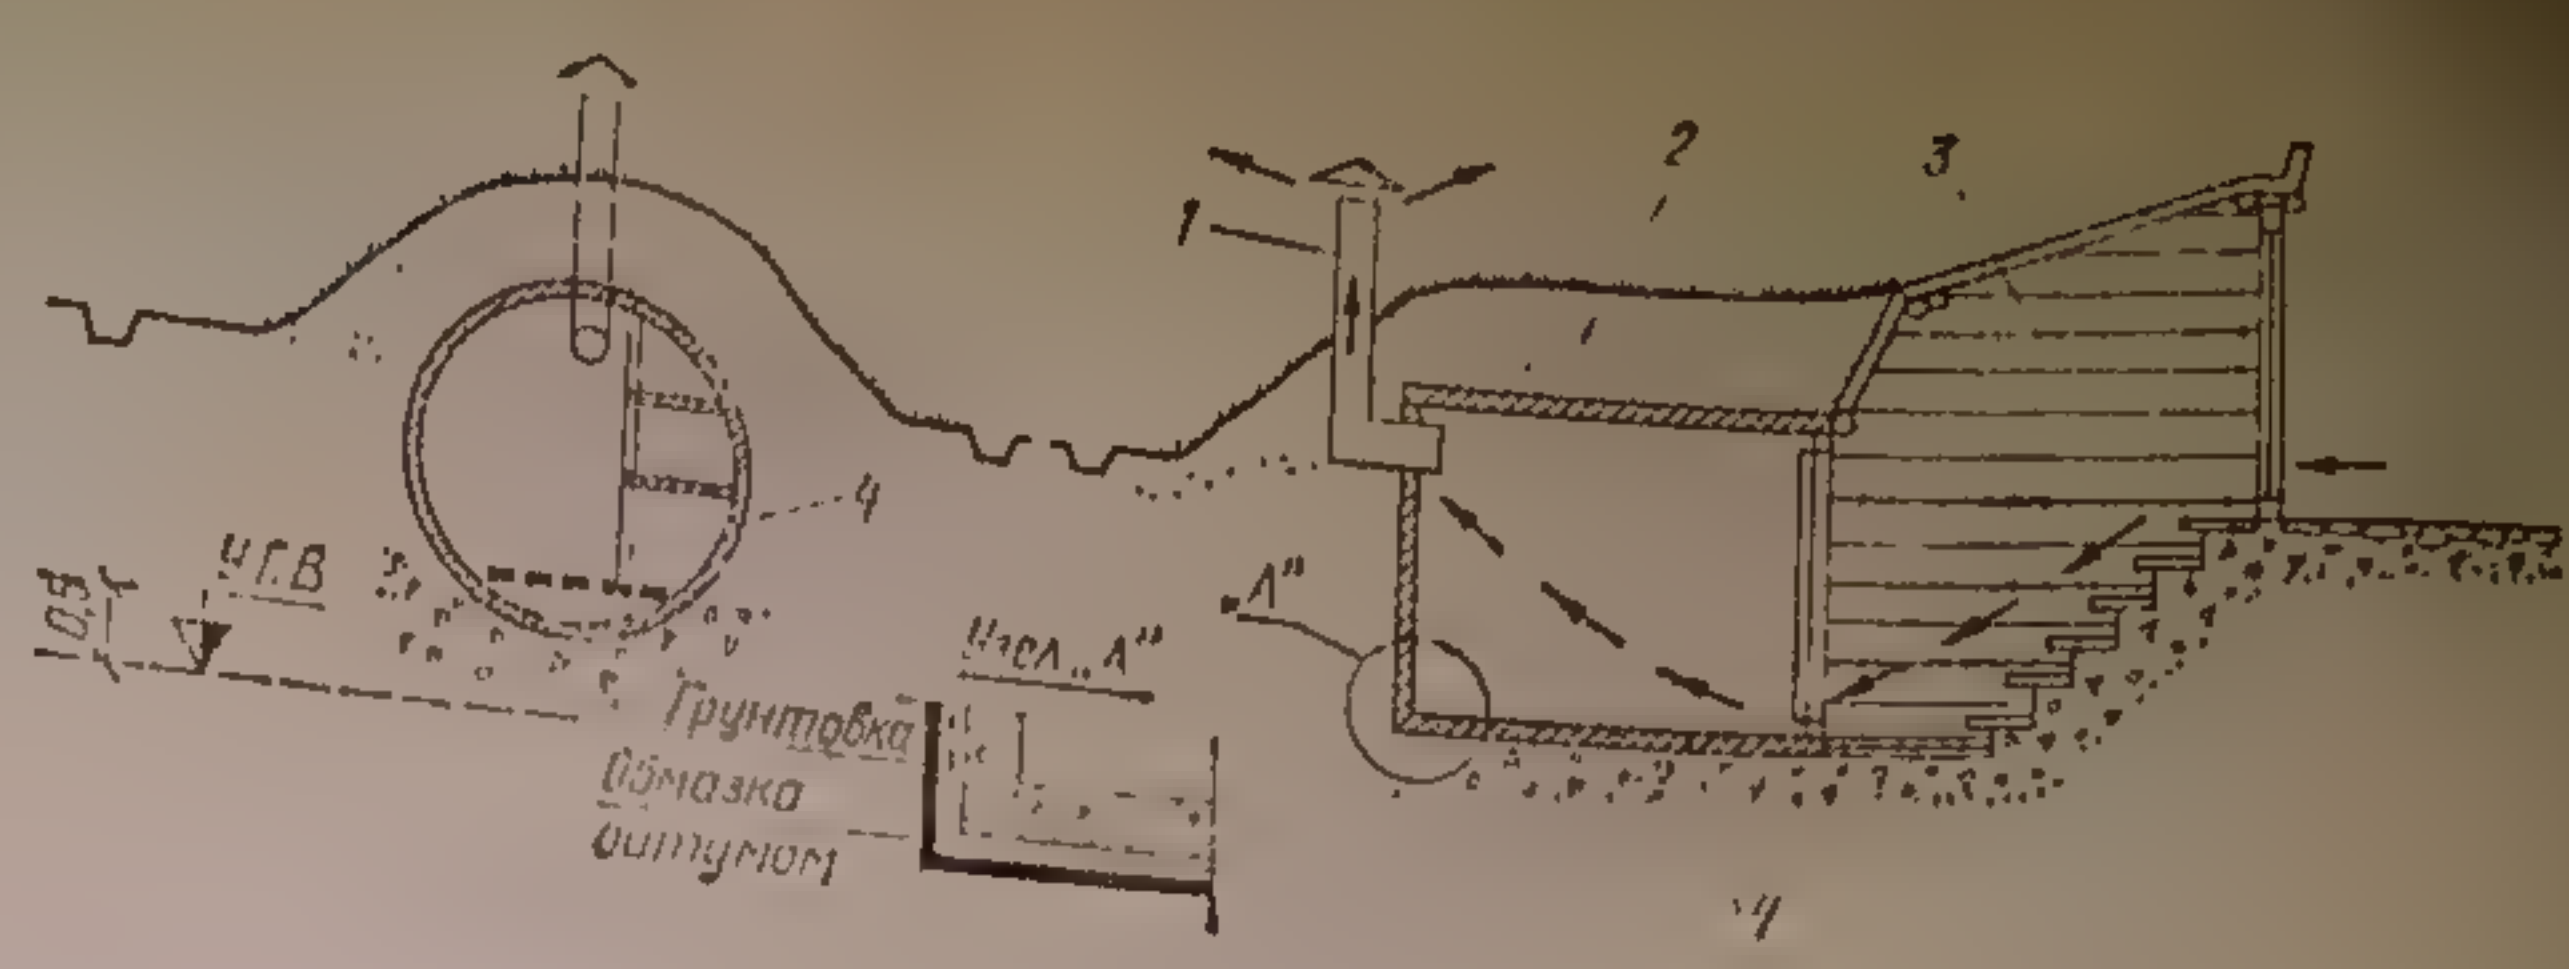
Погреб из железобетонных колец: 1 — вытяжка; 2 — обваловка грунтом; 3 — входной тамбур; 4 — бетонные кольца
